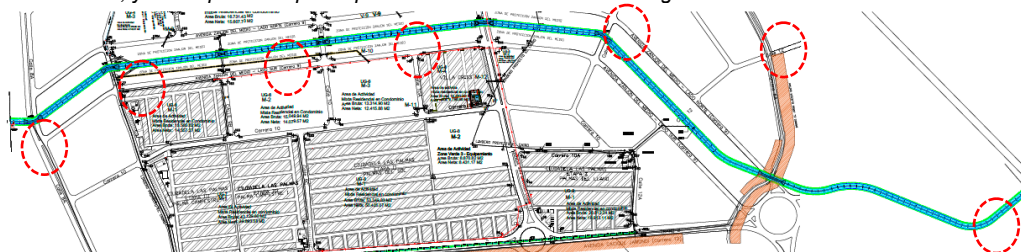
Identificación de las 7 intersecciones sobre el Zanjón Villegas. Tomado y modificado Plano 1 de 12 GMB Ingeniería.
